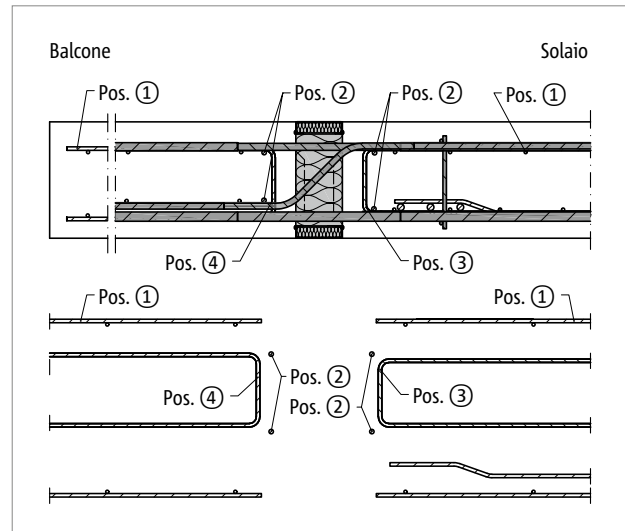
Schöck Isokorb® T tipo K-M13 – M14: armatura in opera con appoggio indiretto
